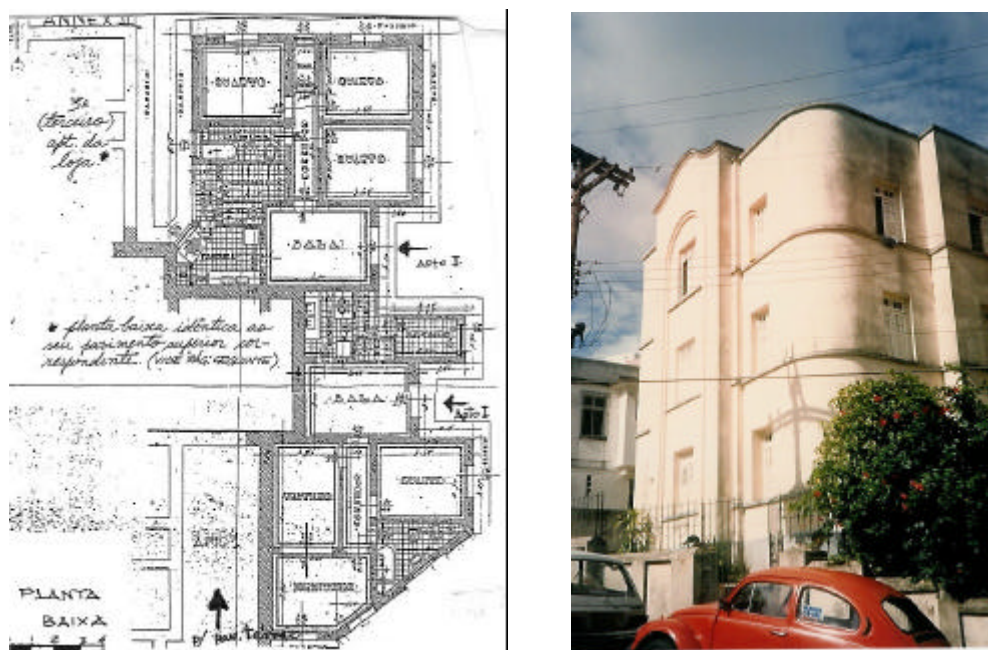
Planta baixa de dois dos apartamentos do Edifício Natal e sua fachada sudoeste.
